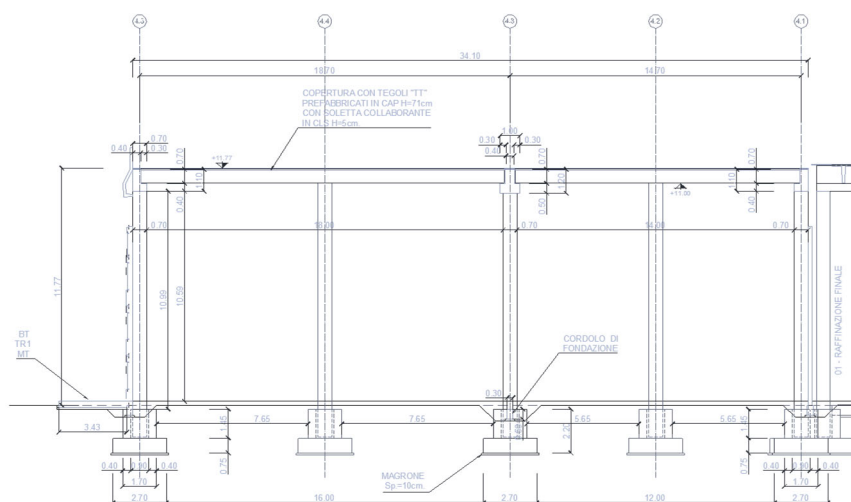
SEZIONE TRASVERSALE MATURAZIONE SECONDARIA
